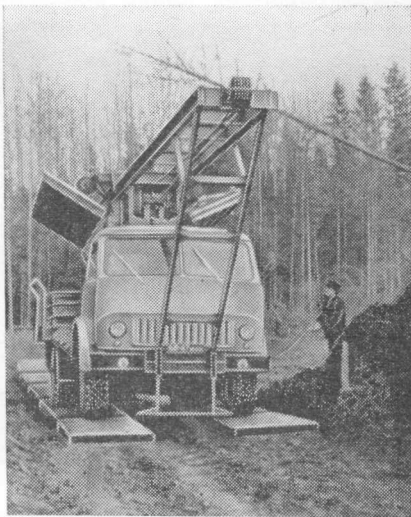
Укладка железобетонных плит плитуукладчиком ДУП-2М
